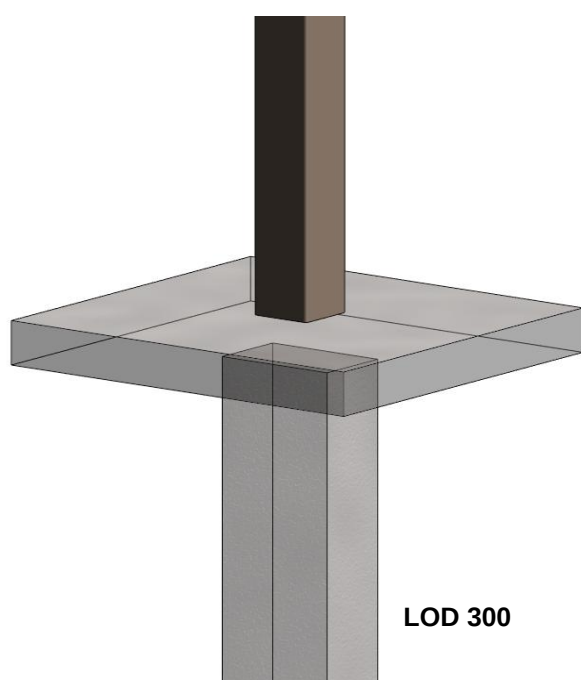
Pormenor sem armaduras e ligações metálicas.
